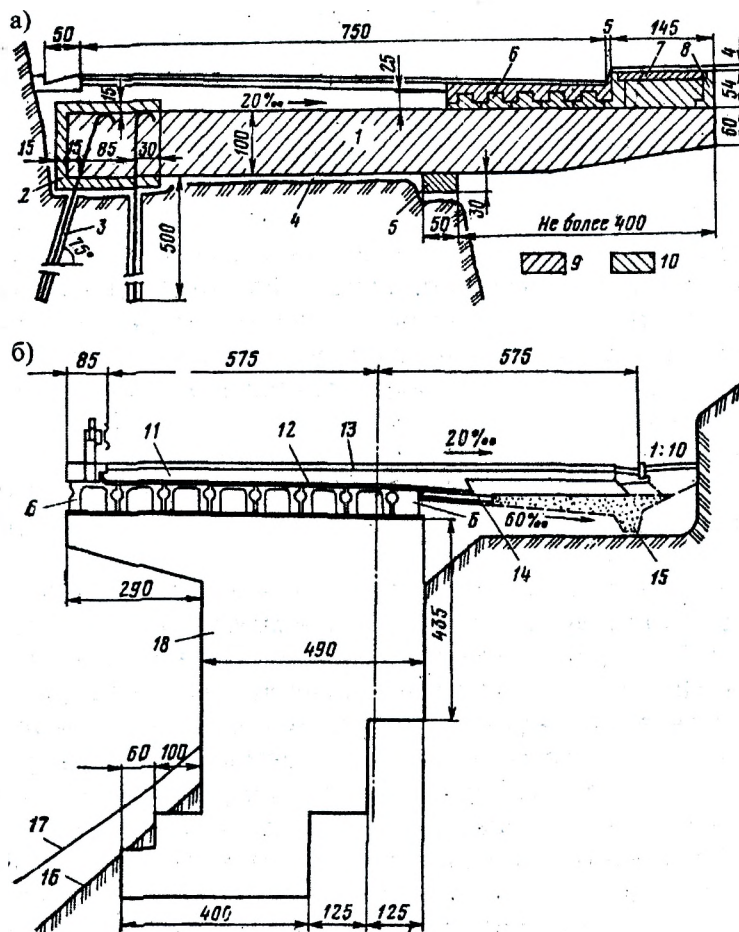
Пример конструкции балкона на заделанных в скалу консольных балках: 1 – несущая консоль; 2 – анкерный блок; 3 – забетонированные в буровых скважинах анкерные стержни  $d=2$  см; 4 – выравнивающий слой бетона; 5 – подкладка; 6 – продольные балки; 7 – тротуарные балки, поддерживающие тротуарную плиту; 8 – тротуарная плита; 9 – продольные балки, поддерживающие тротуарную плиту; 10 – предварительно изготовленные элементы; 11 – бетон, укладываемый на месте; 12 – слой изоляции; 13 – дорожная одежда; 14 – переходная плита; 15 – дренирующая засыпка; 16 – скала; 17 – поверхностный слой грунта; 18 – монолитная железобетонная опора
